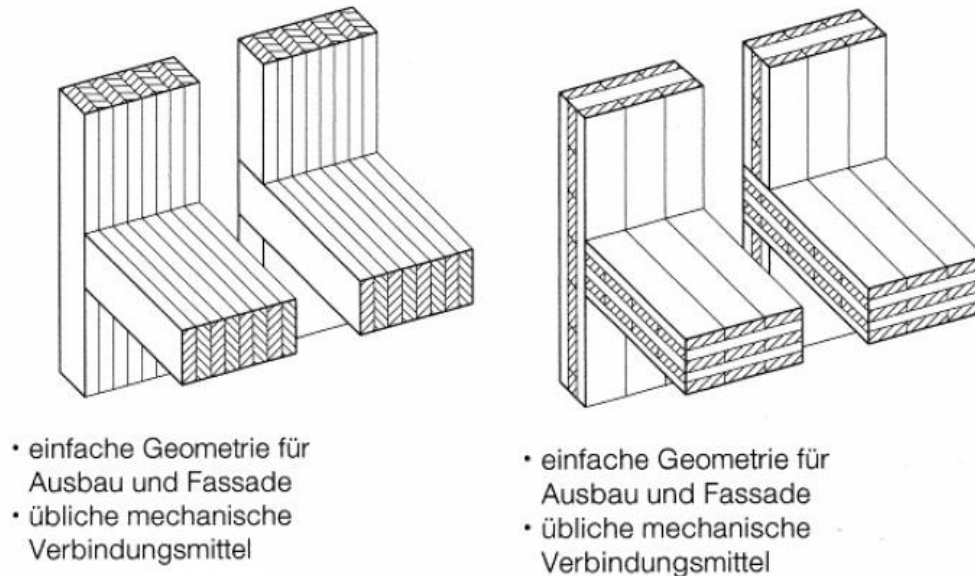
Links: Brettstapelbau, Rechts: Brettsperrholzbau [55]
